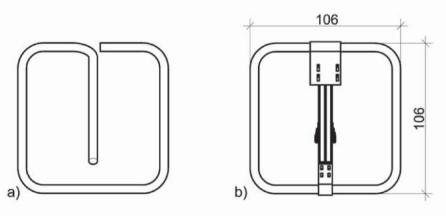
Schöck Isokorb® Typ K mit Sonderbügel
